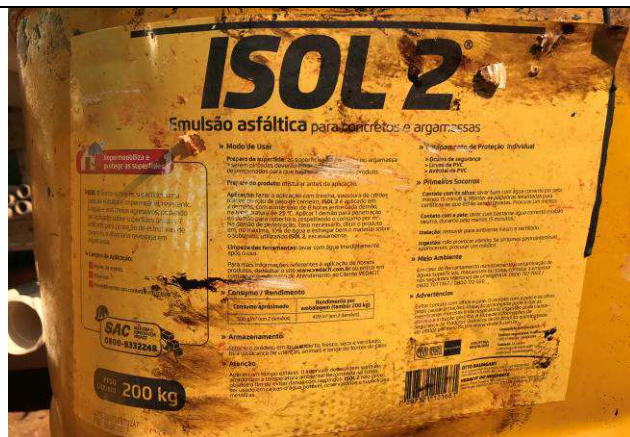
C: Produto utilizado para impermeabilização das vigas baldrame.
